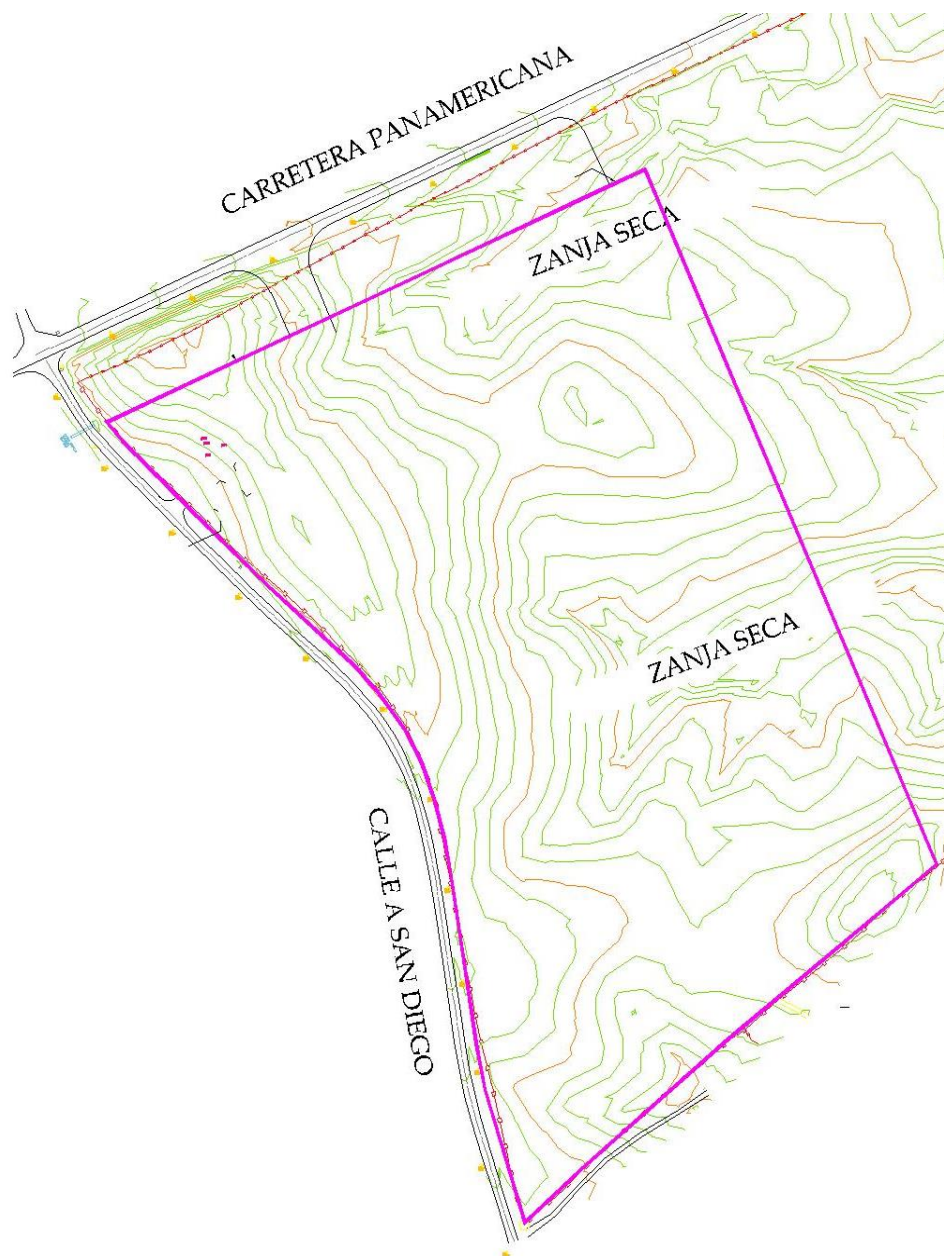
Topografía del Área del Proyecto Master Plan Pacora
